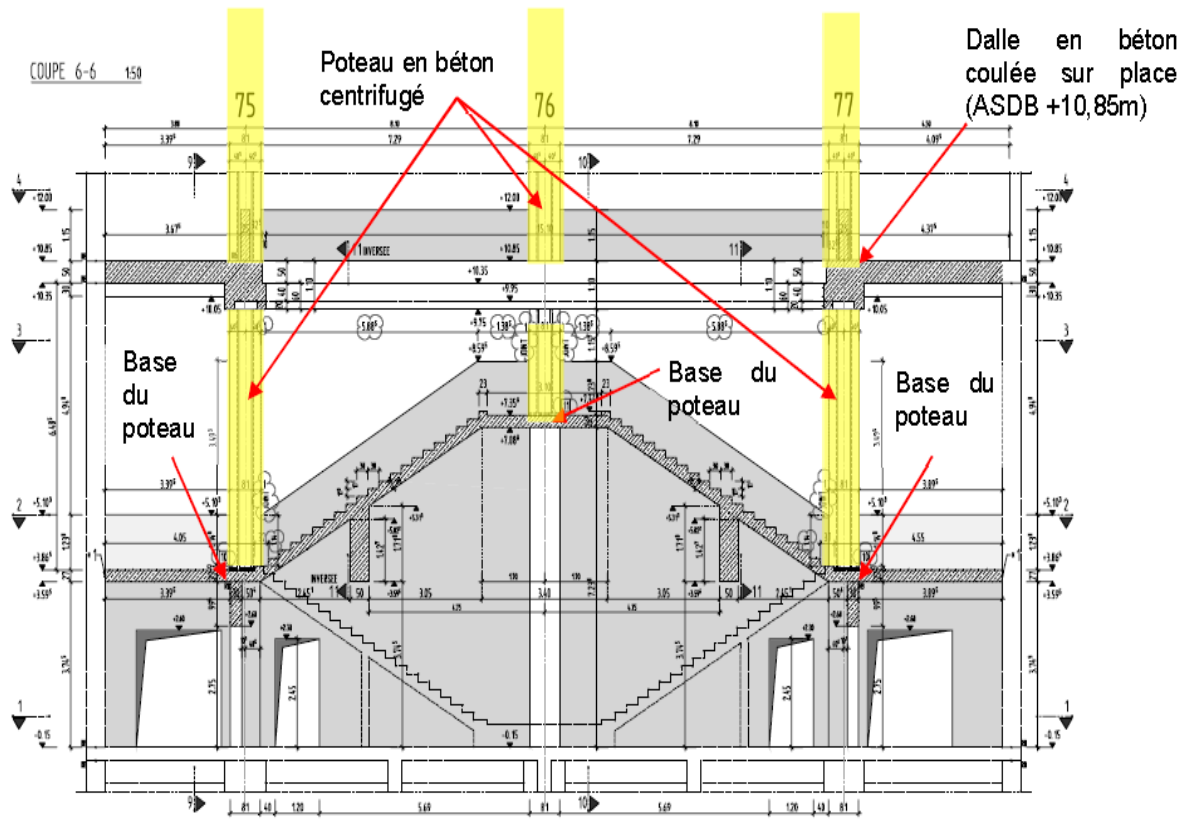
Structure d'un poteau de diamètre 81cm – Type n° 5
